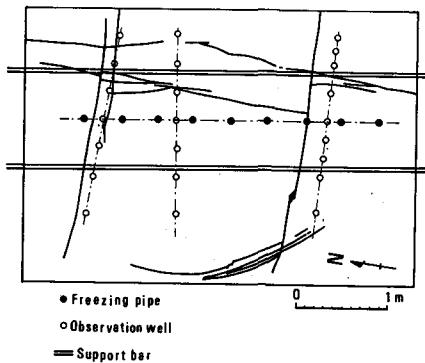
凍結管（黒丸）と観測井（白丸）の配置図
